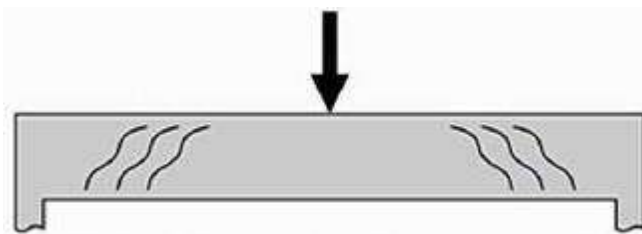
Trincas de flexão em elementos de concreto armado
